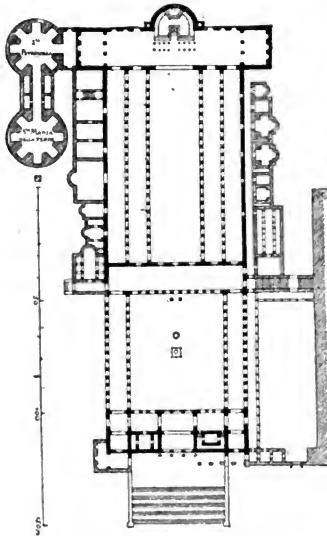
St. Peter in Rom. Grundriss.
